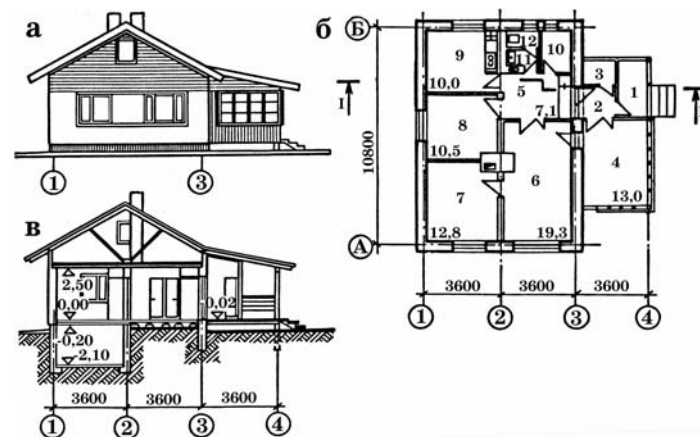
Одноэтажный трехкомнатный дом : а – фасад; б – план; в – разрез I-I; 1 – крыльцо; 2 – тамбур; 3 – холодная кладовая; 4 – веранда; 5 – прихожая; 6 – общая комната; 7, 8 – спальни; 9 – кухня-столовая; 10 – кладовая; 11 – шлюз; 12 – люфт-клозет.
